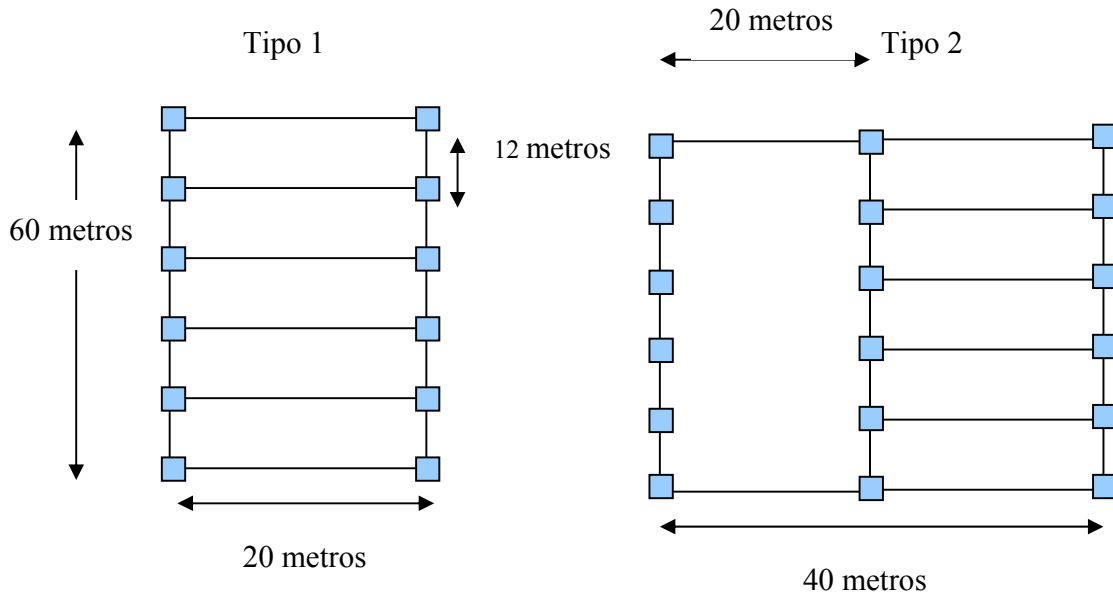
PLANTAS TIPO DE EDIFICIOS INDUSTRIALES ESTRUCTURADOS CON COLUMNAS EN VOLADIZO
